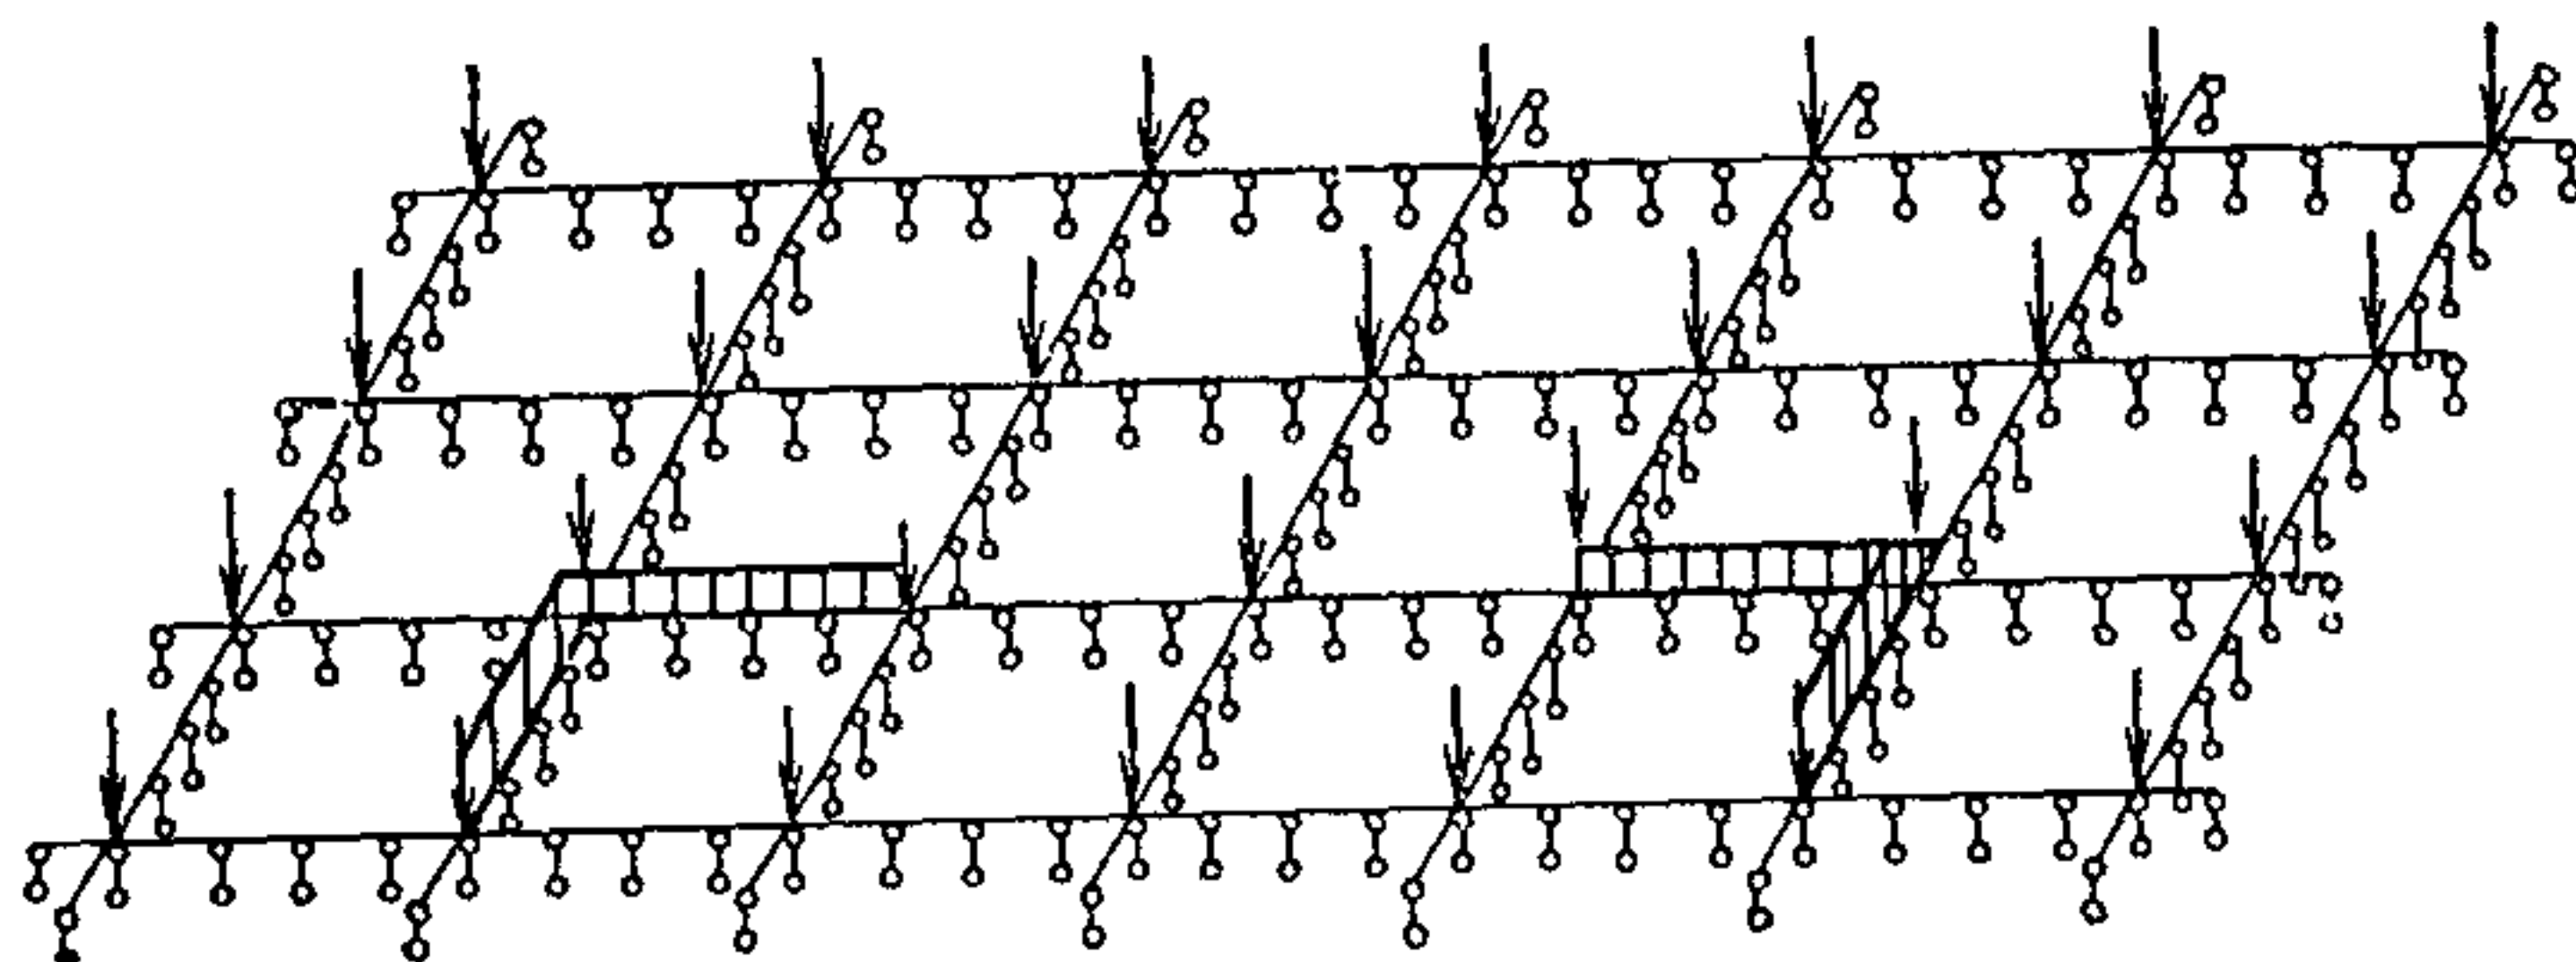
Расчетная схема прямоугольной плиты в виде системы перекрестных балок на дискретных упругих опорах
